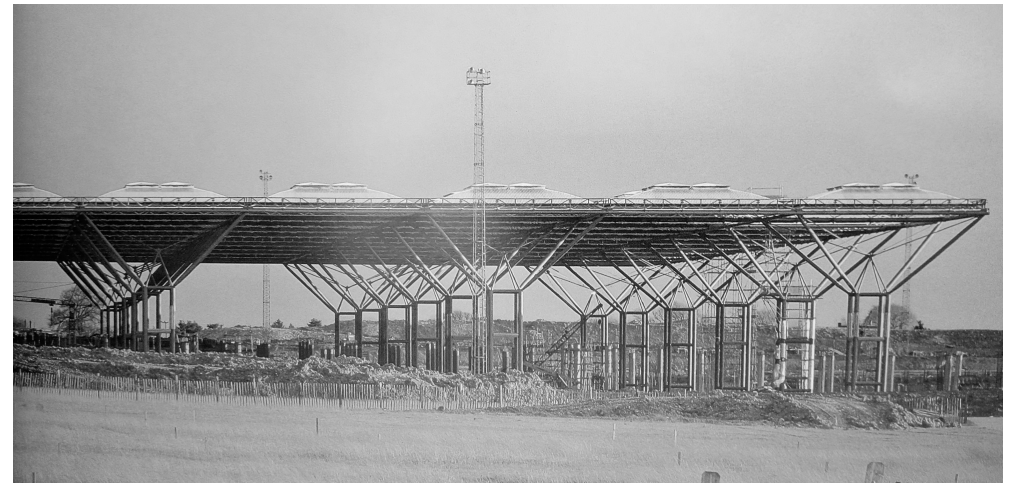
Vista de la estructura metálica con la cubierta ya dispuesta (Verano de 1987)
